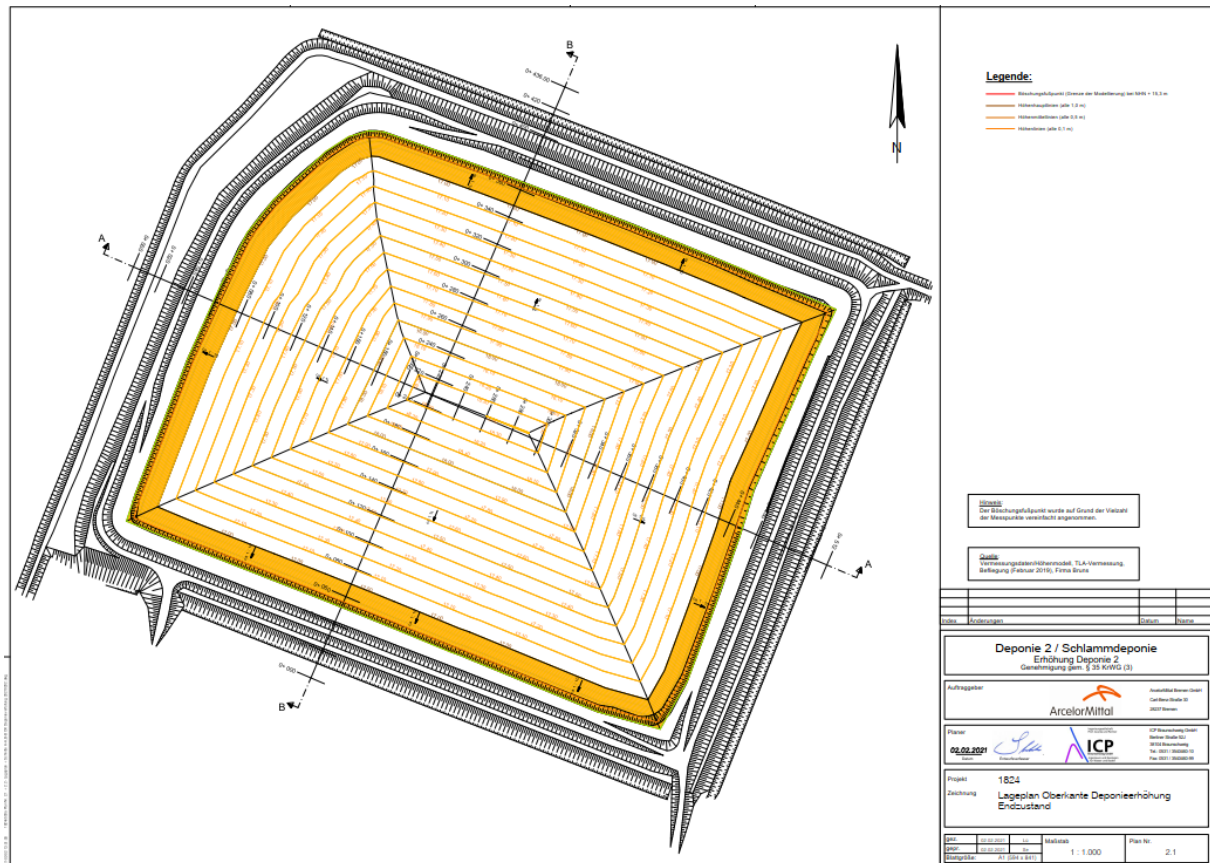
Lageplan Oberkante Deponieerhöhung Endzustand (ICP Braunschweig GmbH, 02.02.2021)
